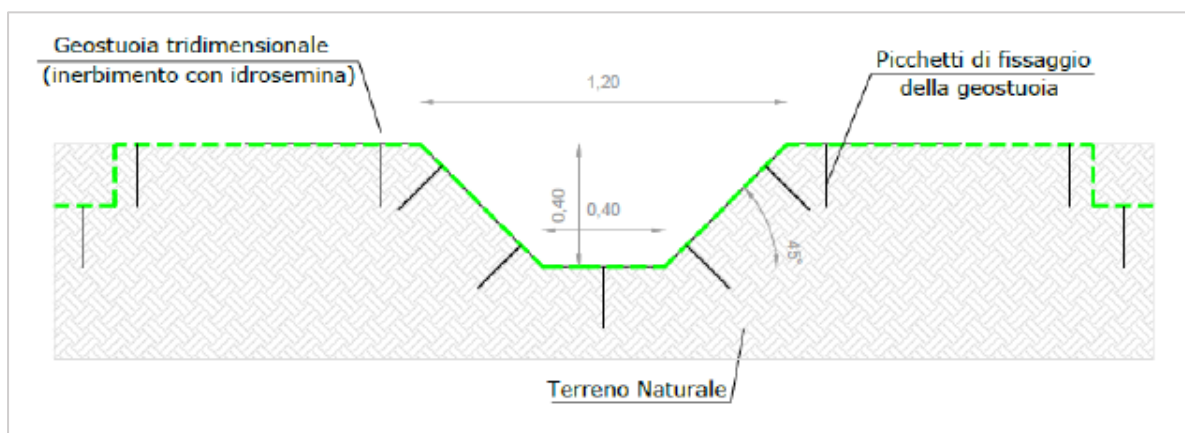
Sezione drenaggio – Canale trapezoidale in terra
